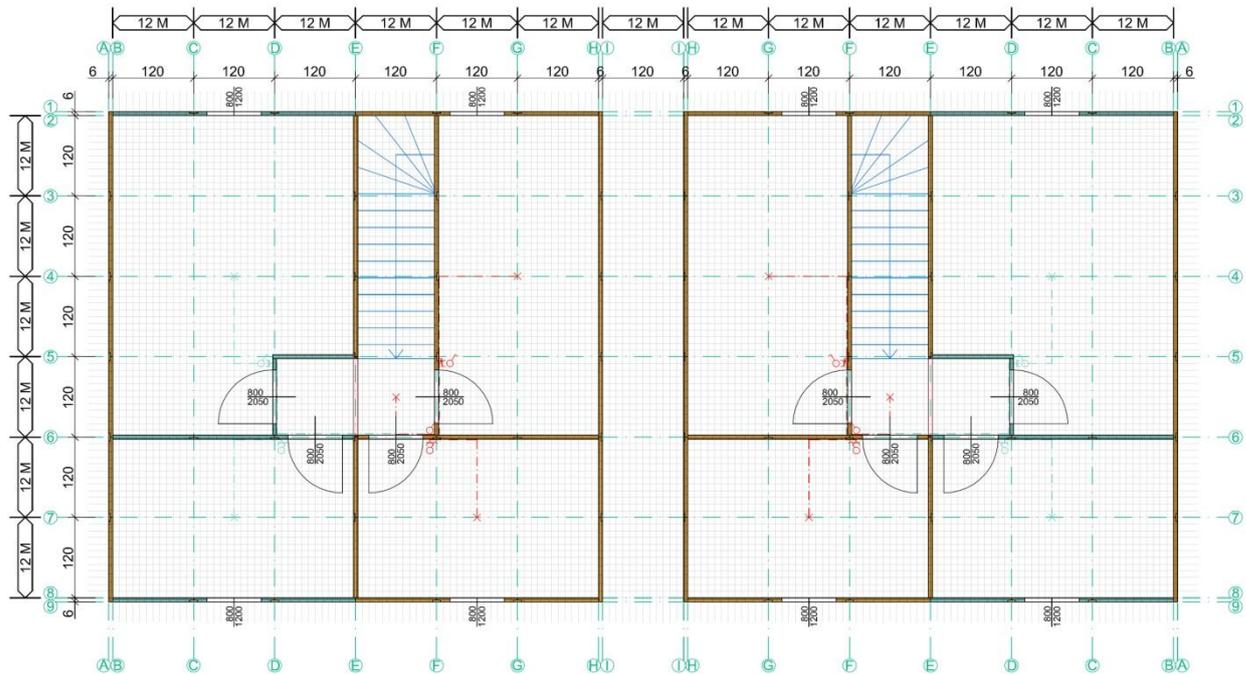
Grundriss des Obergeschosses zweier Häuser (Erweiterungsstufe)
